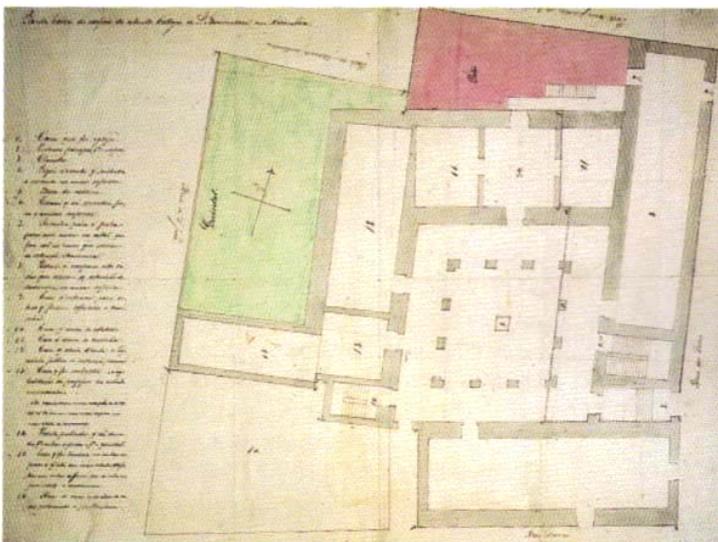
Planta do piso térreo do Colégio de S. Boaventura, séc. XIX.
